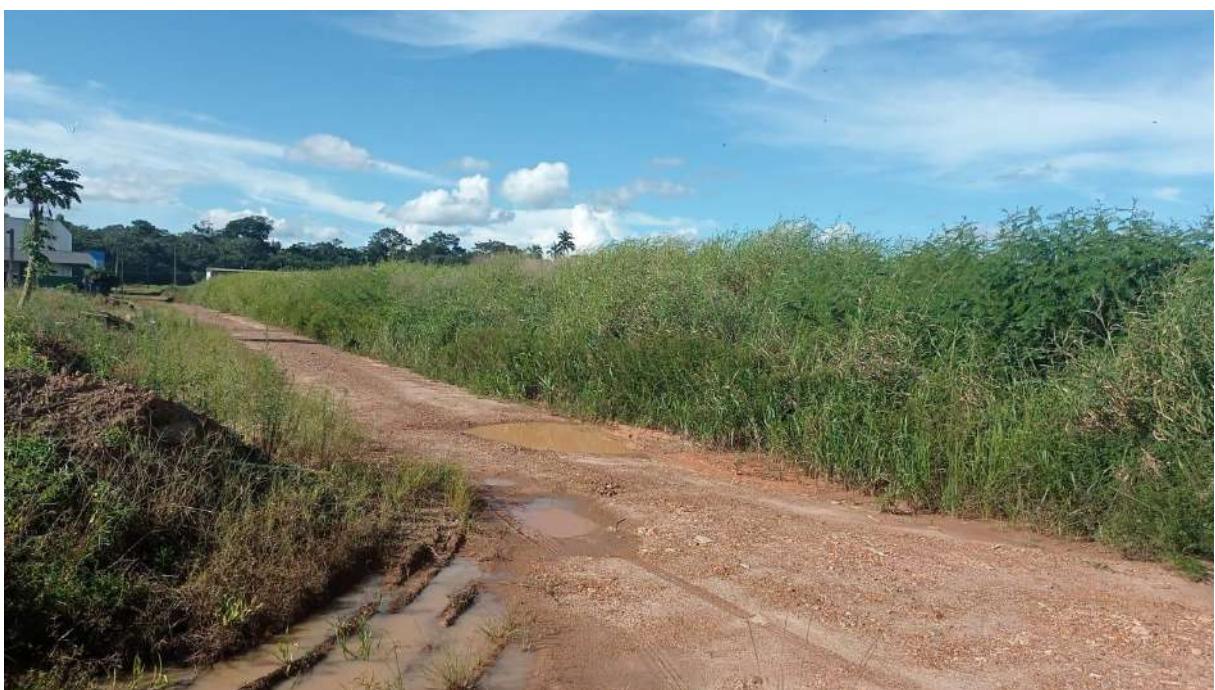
Registro esquina Av. Ozoribo Furlan com Av. Ângelo Cassol
